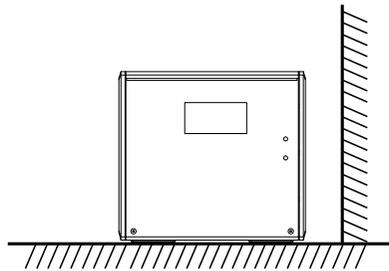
Installationsabstand zu benachbarten Objekten)
